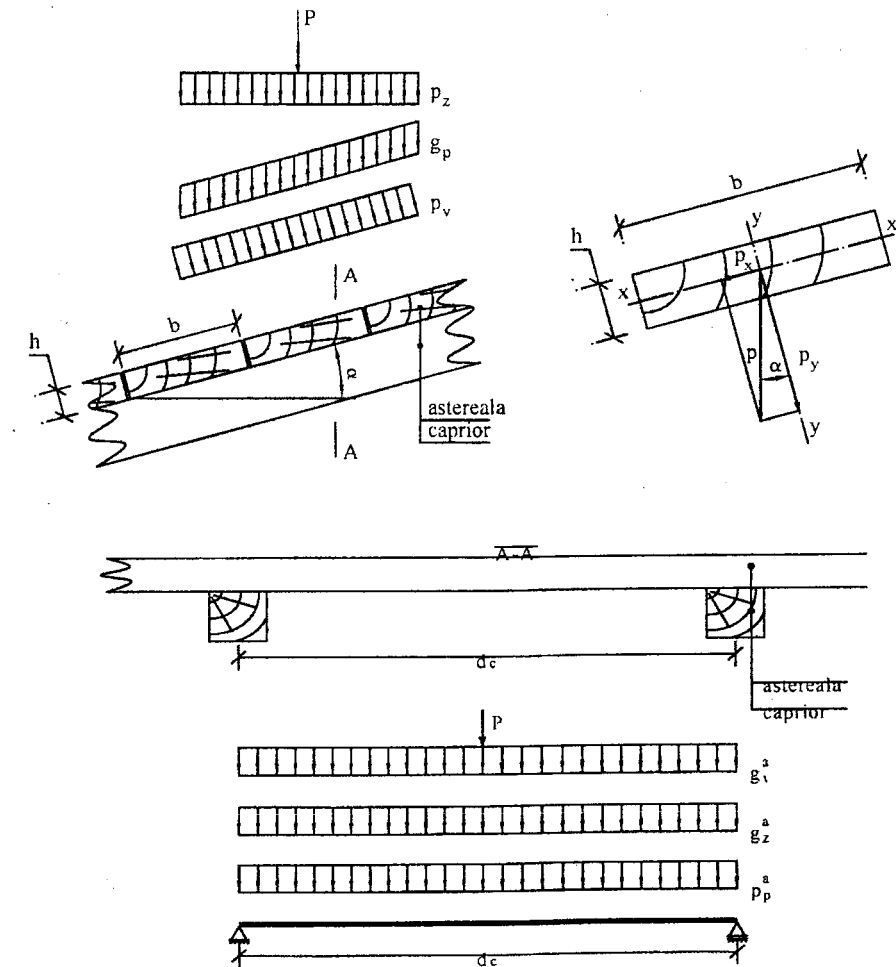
Stabilirea schemei de calcul și a încărcărilor pentru astereală
